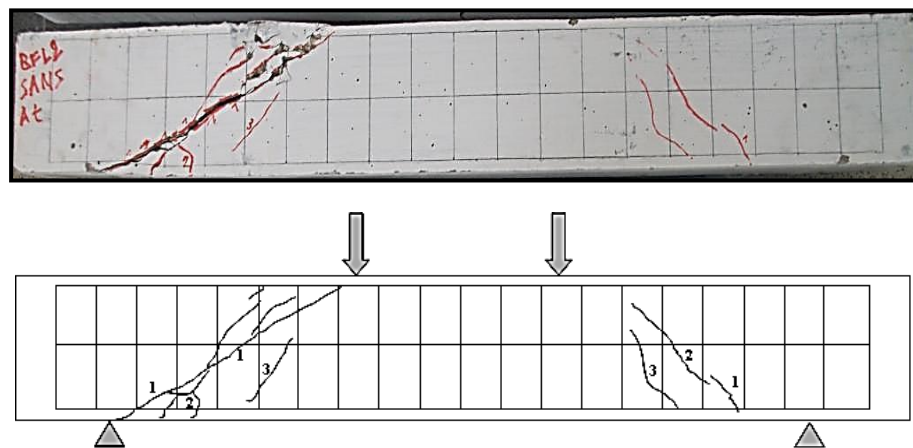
Destruction et fissuration finale de la poutre PBFL2 sans At.
